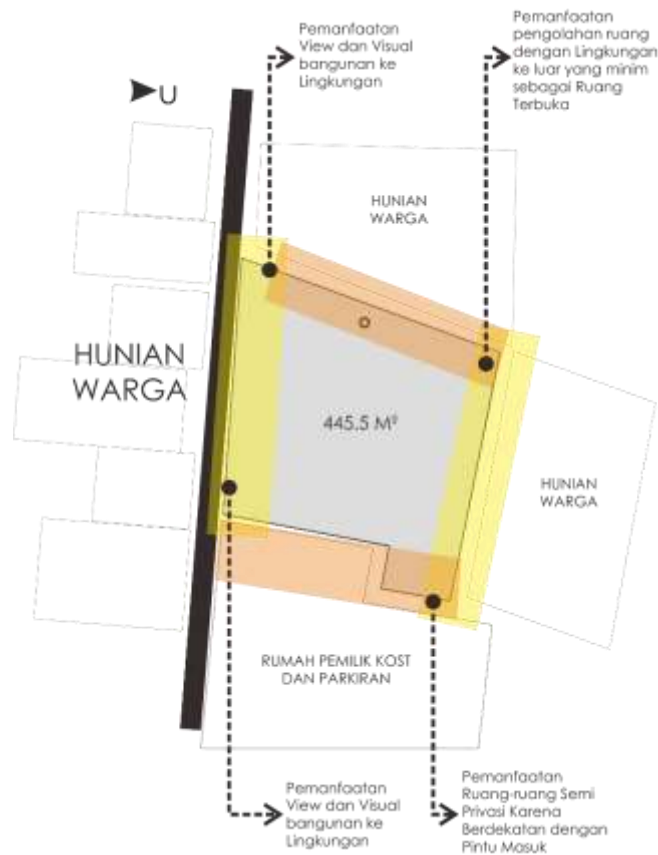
Denah Dan Ukuran Bangunan Eksisting
